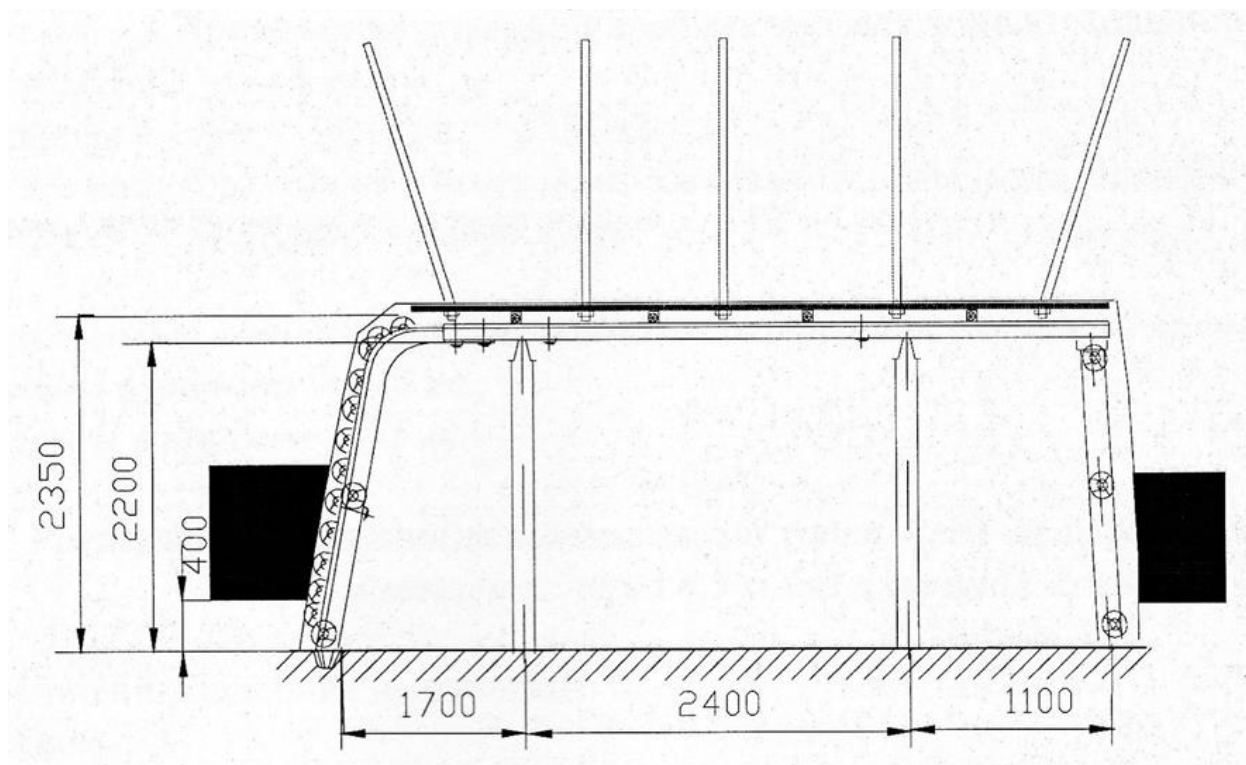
Крепление монтажного ходка в сочетании с анкерами.
